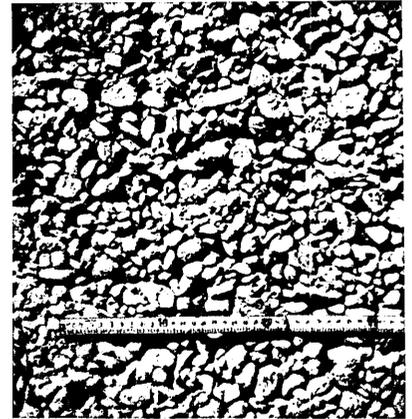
Ausschnitt aus einer lot- rechten Abschlußfläche von Sicker- beton (Gleisbergtunnel-Südportal).
